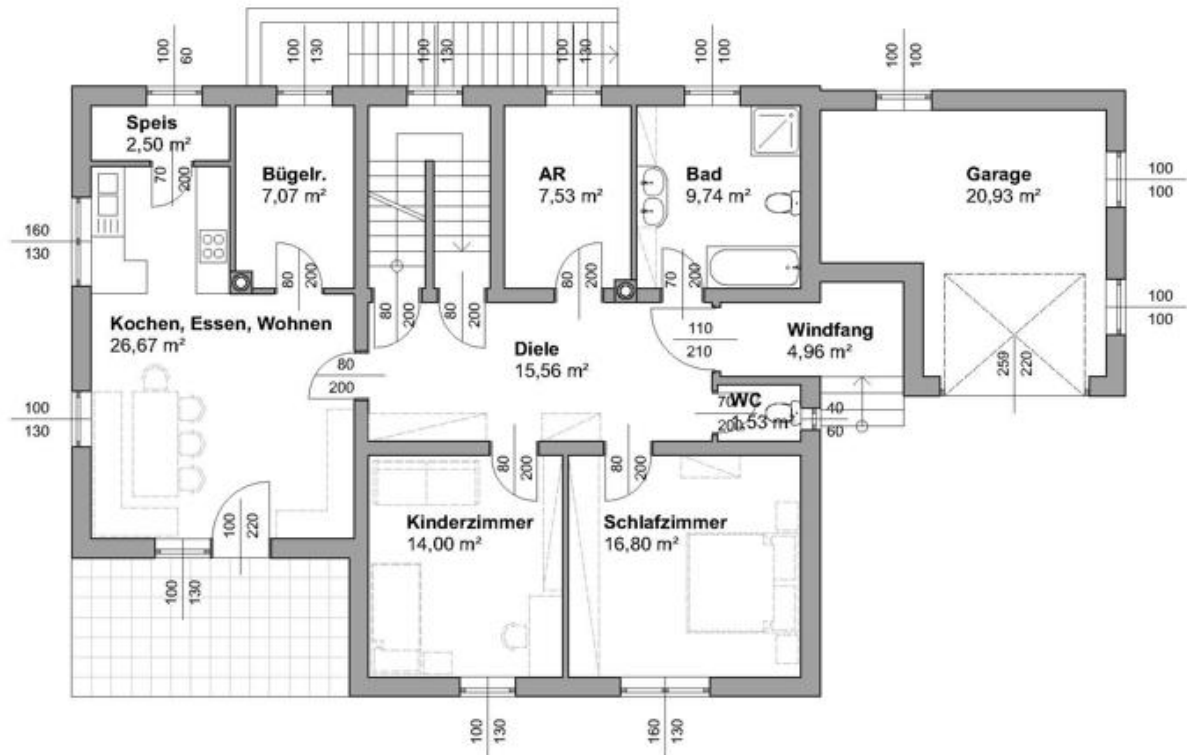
Mustergrundriss eingeschossiges Einfamilienhaus 1987 – Bestand (Maßstab 1:100)
